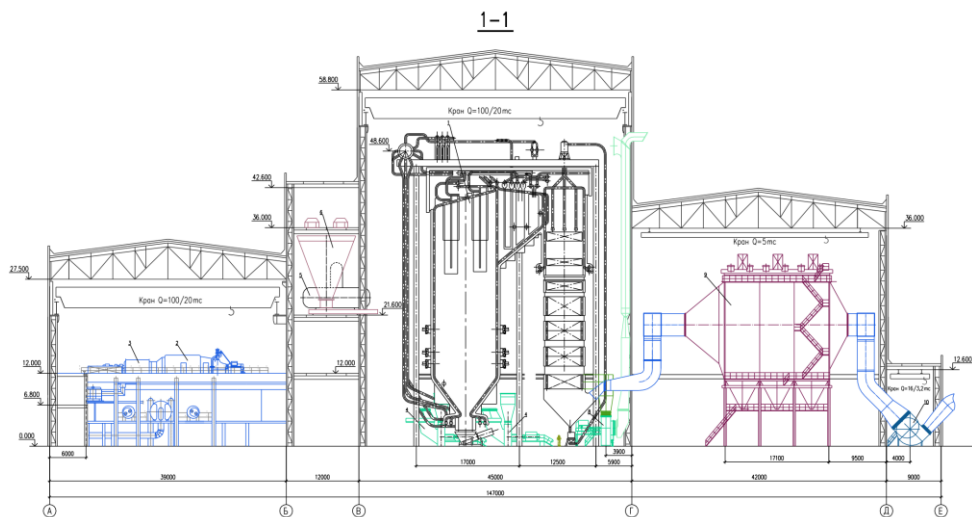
Поперечный разрез главного корпуса типовой ТЭЦ [34]
